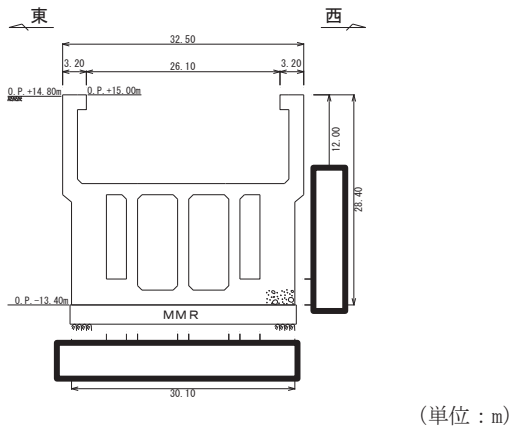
海水ポンプ室断面図 (B-B 断面, 東西)
